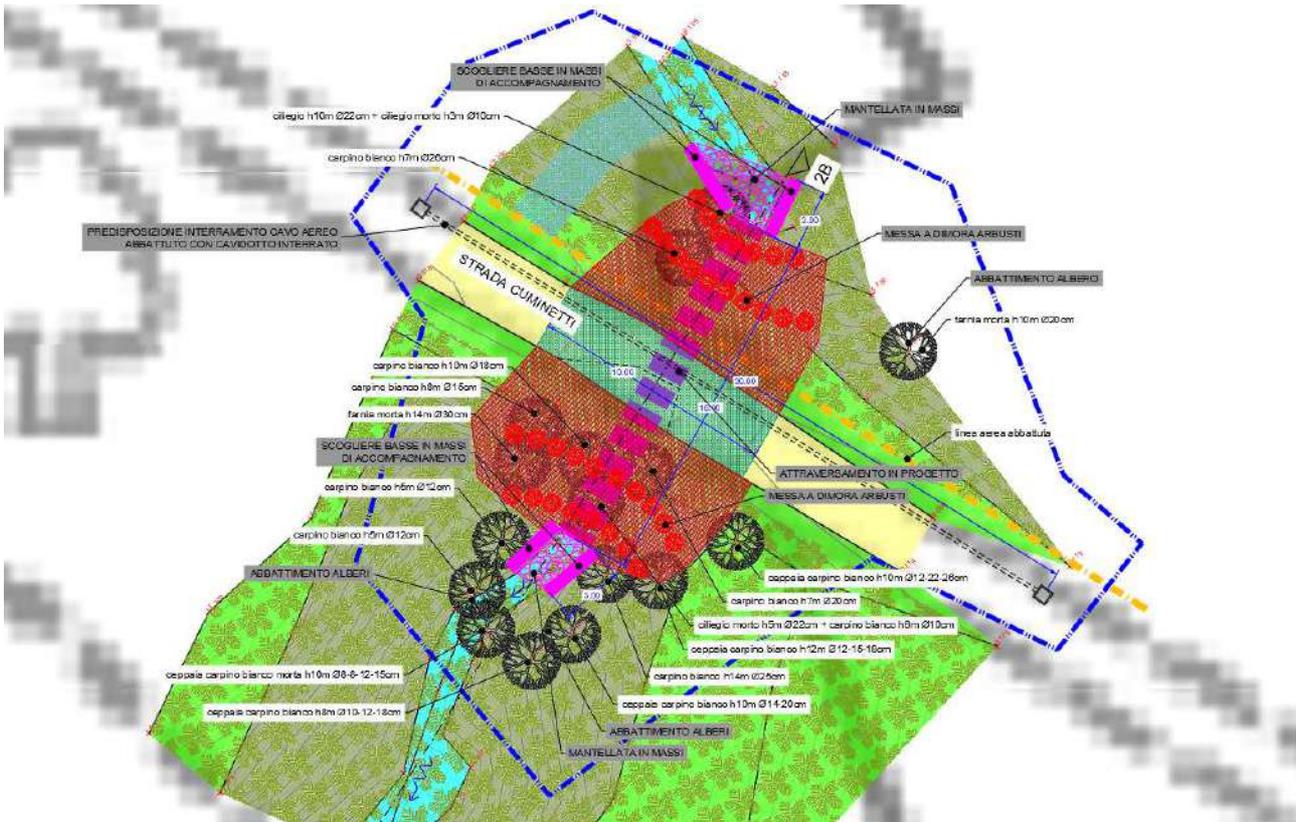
Planimetria di progetto. (rappresentazione non in scala)
